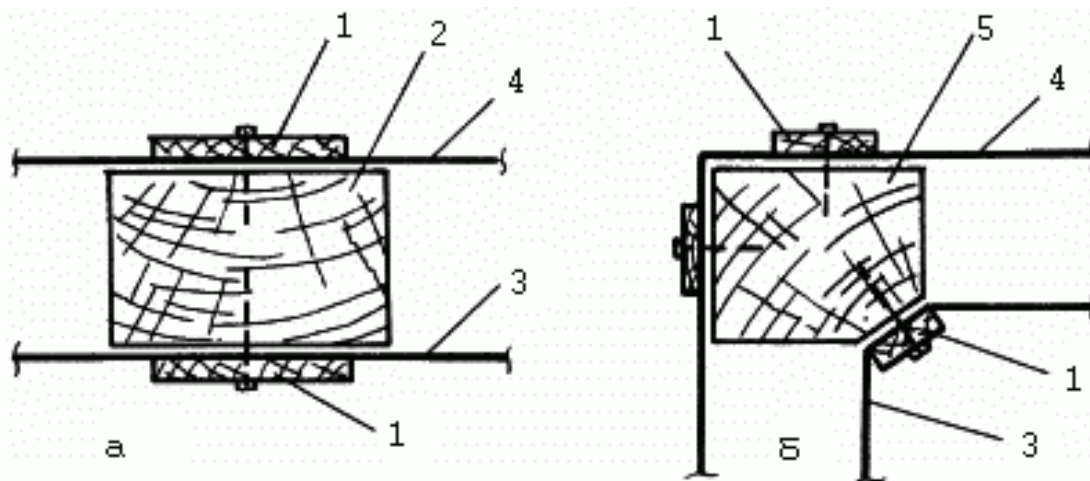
Крепление двойной обшивки парника: а – в профиль; б – вид сверху; 1 – рейка; 2 – вертикальный брус; 3 – внутренняя пленка; 4 – внешняя пленка; 5 – крайний брус
